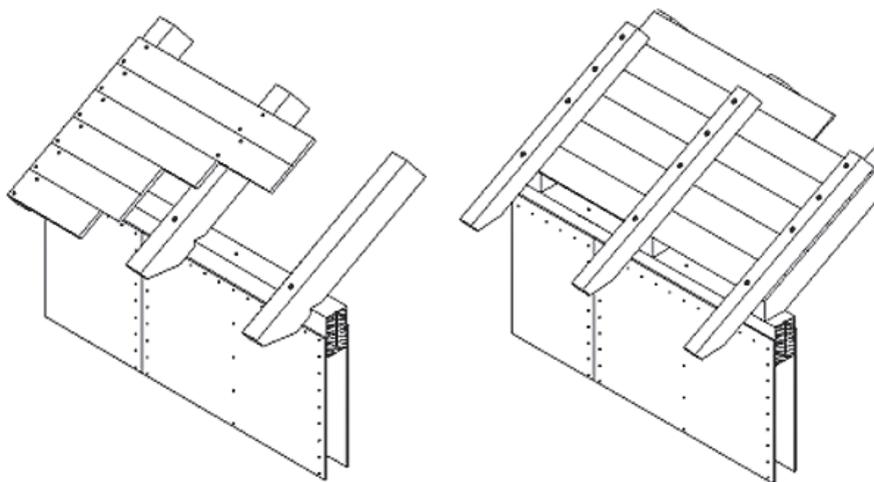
Copertura a travetti di un edificio intelaiato: soluzione con travetti continui in appoggio sulle pareti esterne oppure soluzione con "falsi travetti" in gronda
